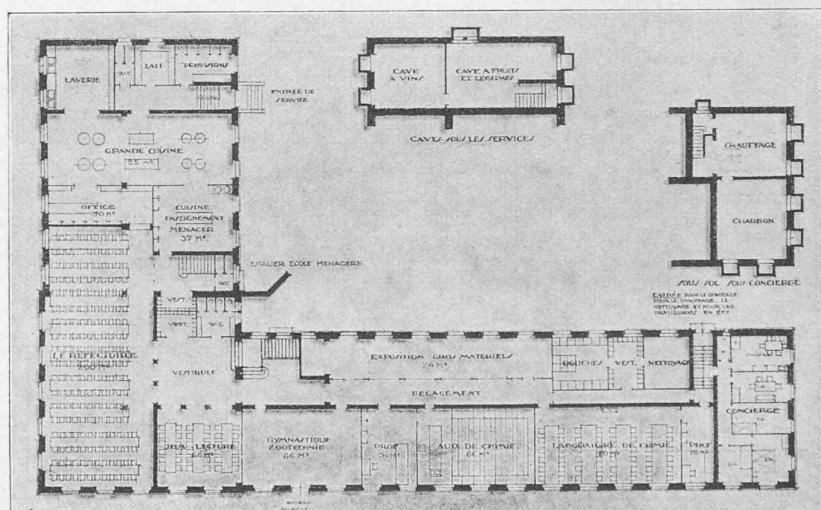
Plan du rez-de-chaussée inférieur. — 1 : 600.
